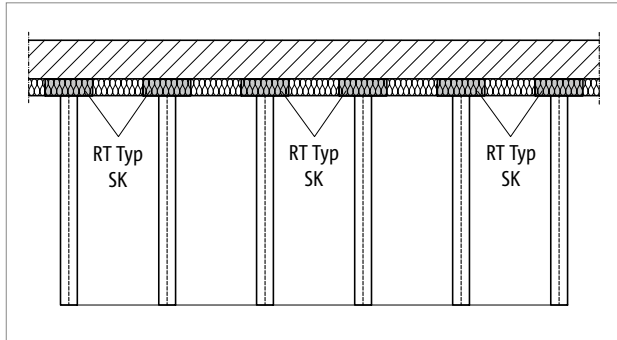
Schöck Isokorb® RT Typ SK: Erneuerung eines Bestandsbalkons, frei auskragend
